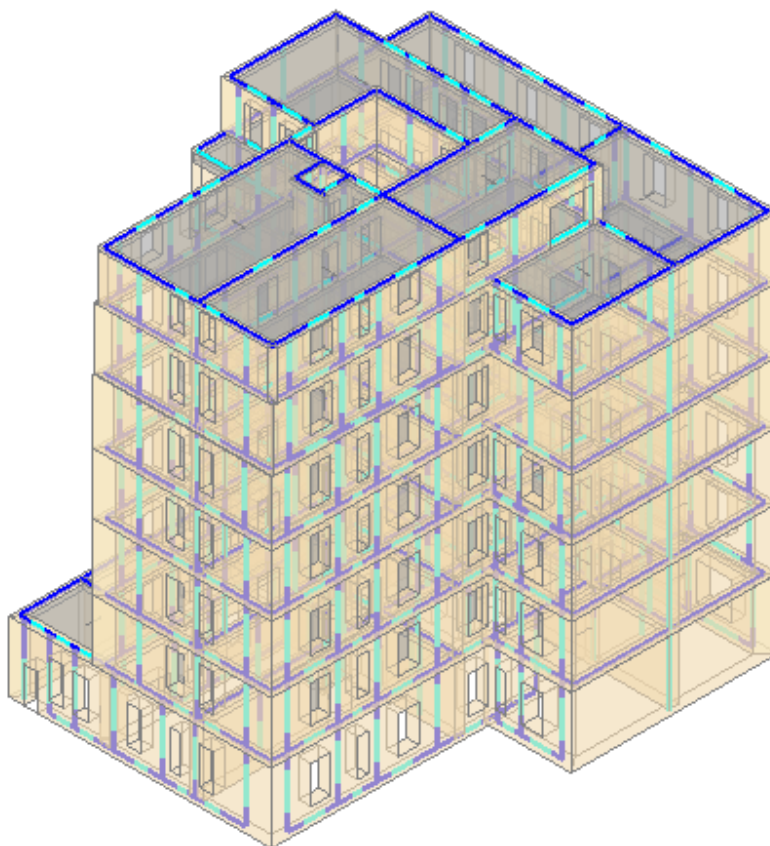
Vista estrusa del modello di calcolo tridimensionale utilizzato
